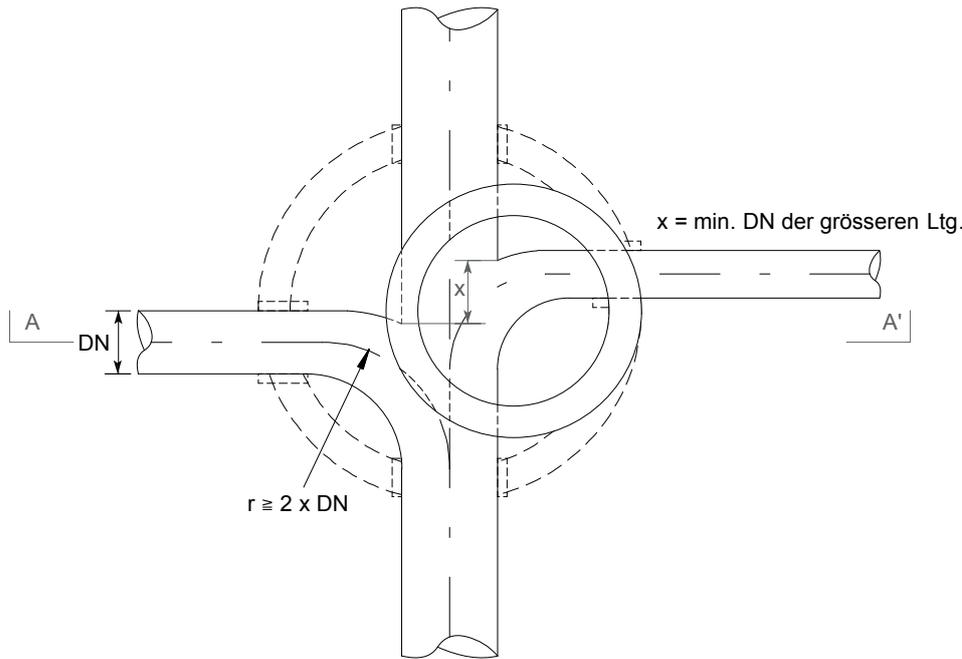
Grundriss: Einstiegsschacht 1000/600, nach VSA
